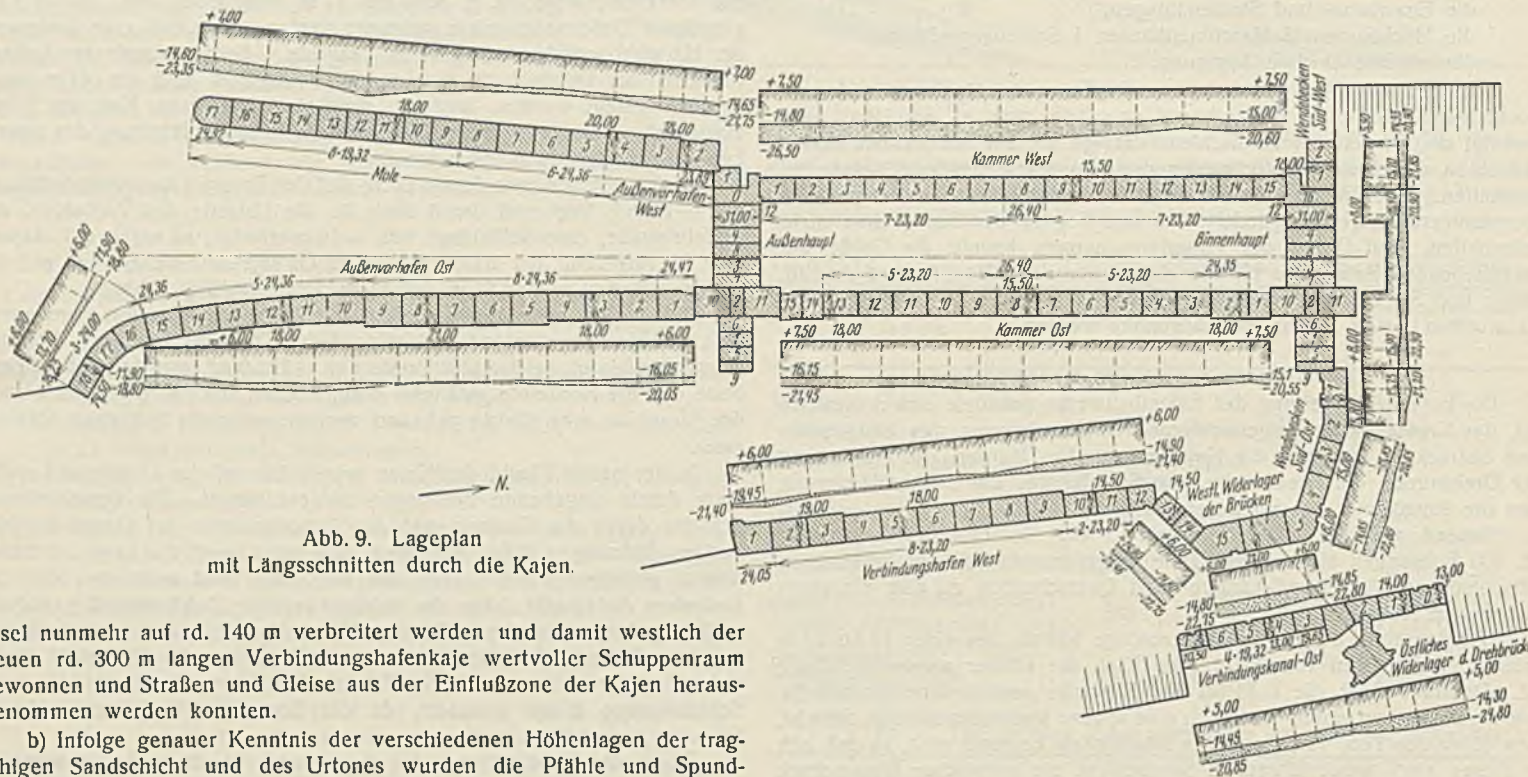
Lageplan mit Längsschnitten durch die Kajen.
